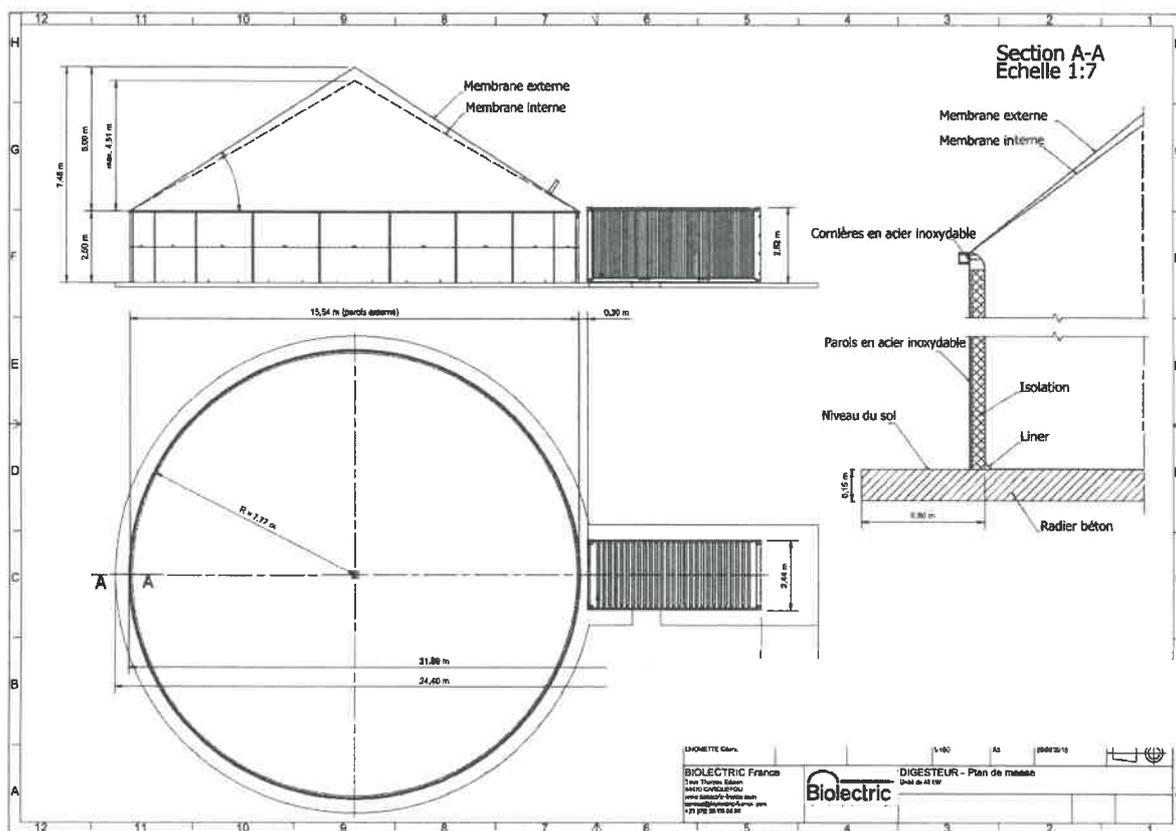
Présentation des ouvrages (voir plan format A3 en fin de document)
